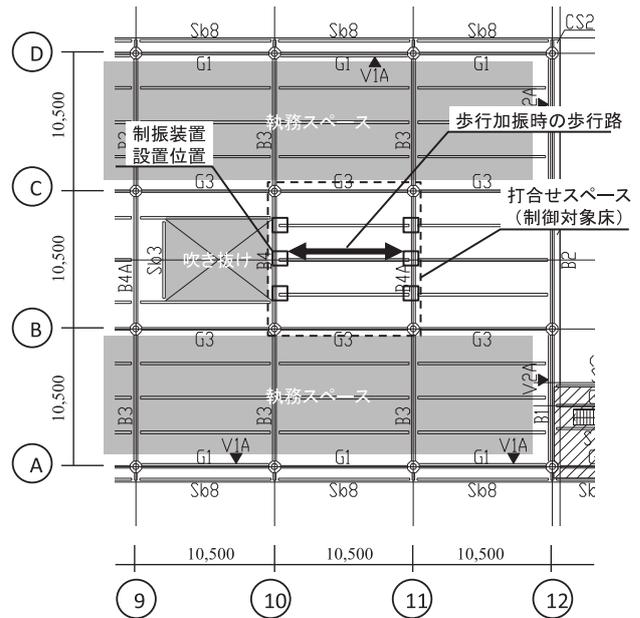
施工性、制振性能検証の対象とした実建物の平面図(一部)
